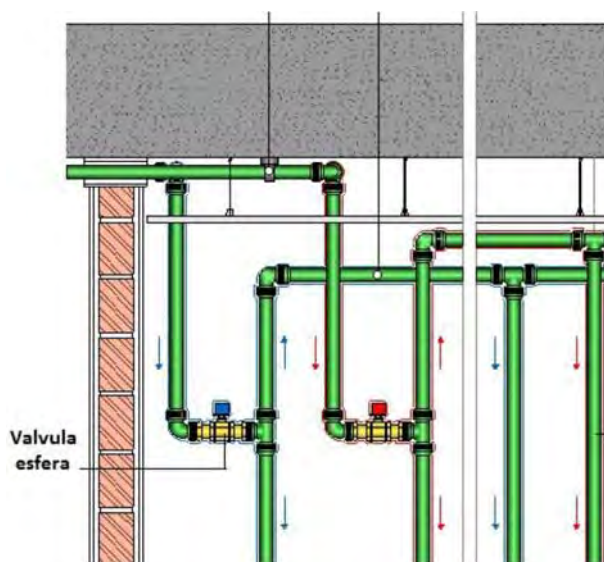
Detalle tipo de fontanería y llaves de corte, 2016, CYPE
